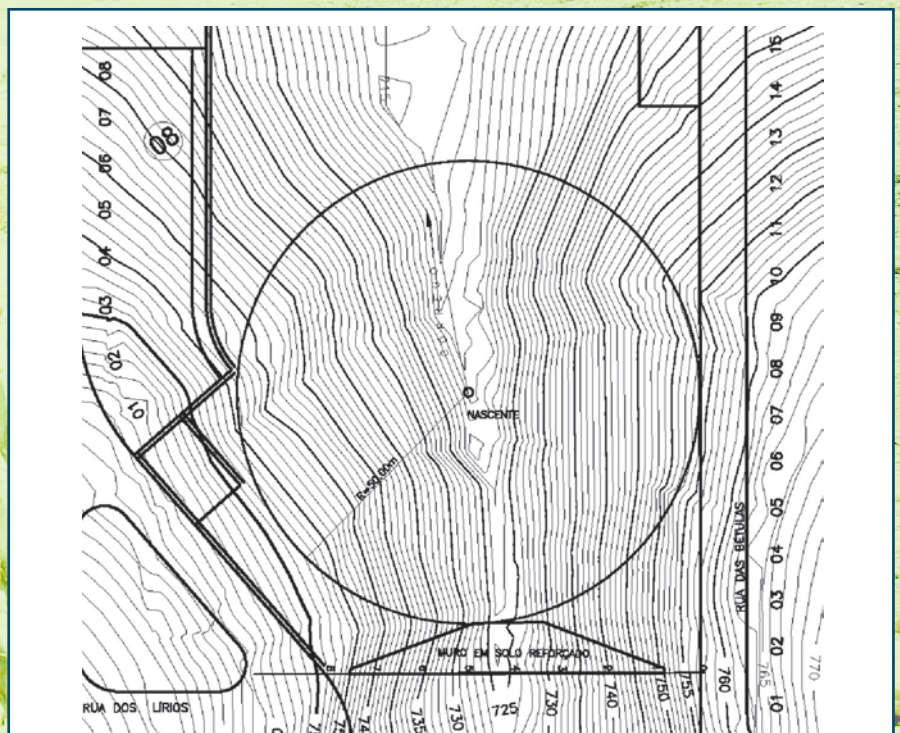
Planta com curvas de nível, posição da nascente e do muro
